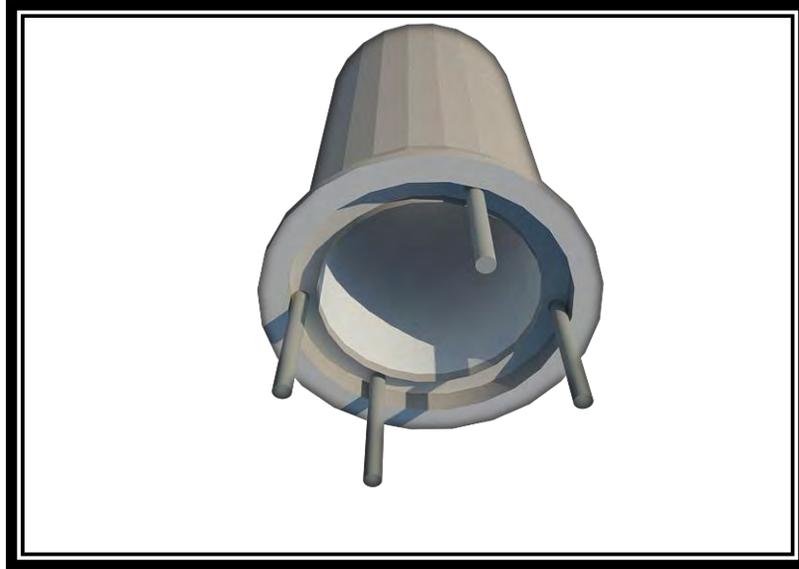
Sección de una tubería fabricada de concreto con acero de refuerzo.
